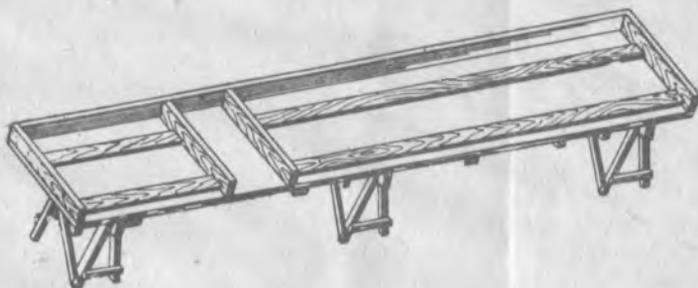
Верстак стахановца Ерохина для сборки щитов подбора и перегородок
